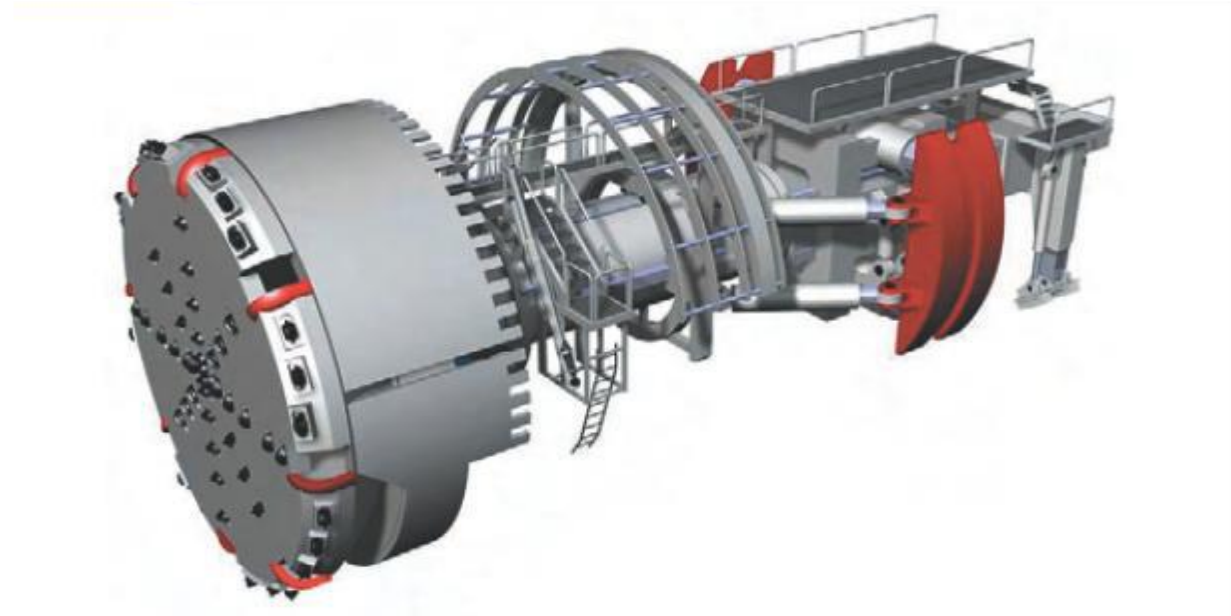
Tunnelier pour la construction du tunnel de base St. Gothard. Soutènement par ancrage, cintres et béton armé (Simic, 2008)
